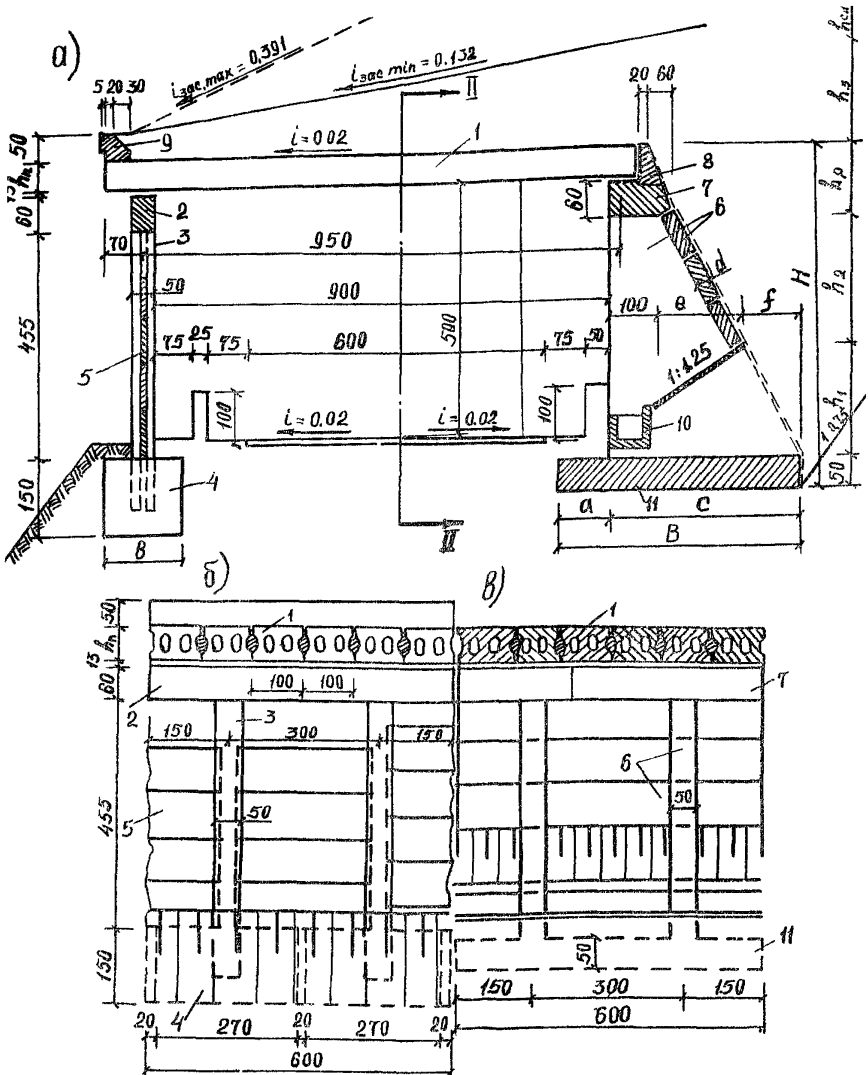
Галерея с одноярусными пустотными плитами перекрытия и верхней стеной в виде поперечных стенок с закладными блоками для дорог IV-V категорий:
